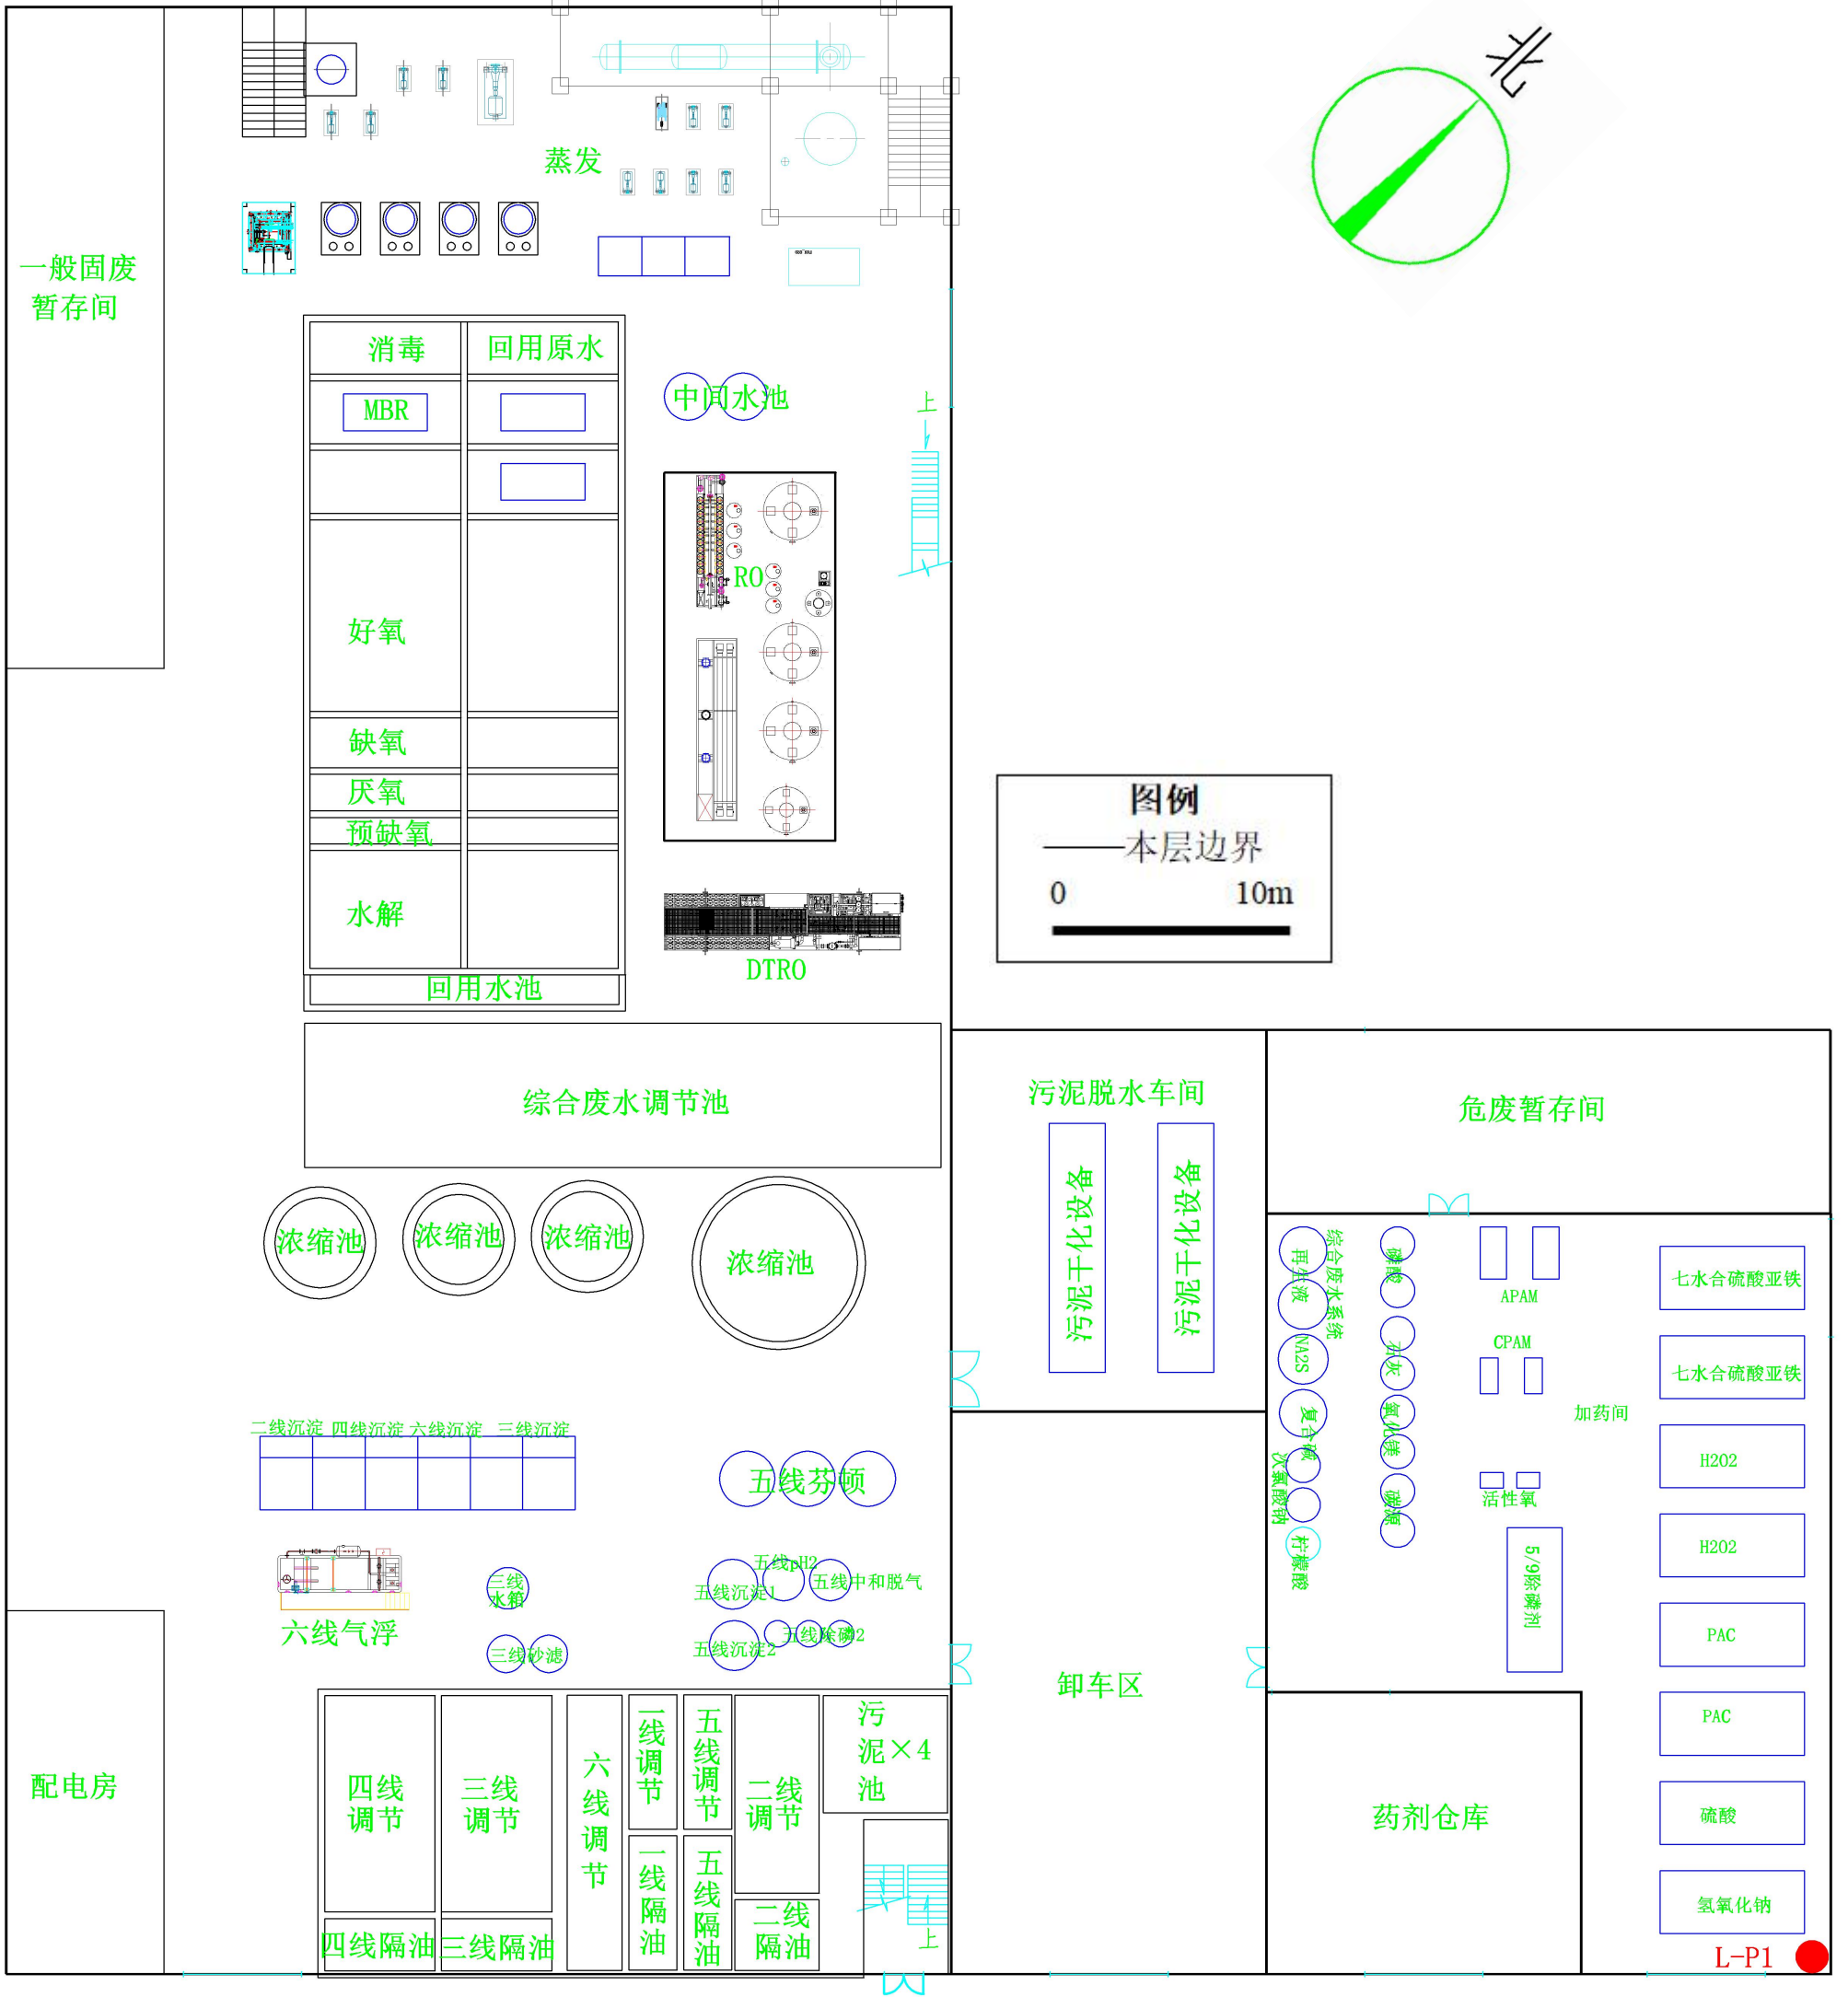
(a) 污水处理车间总平面图 (一层)
